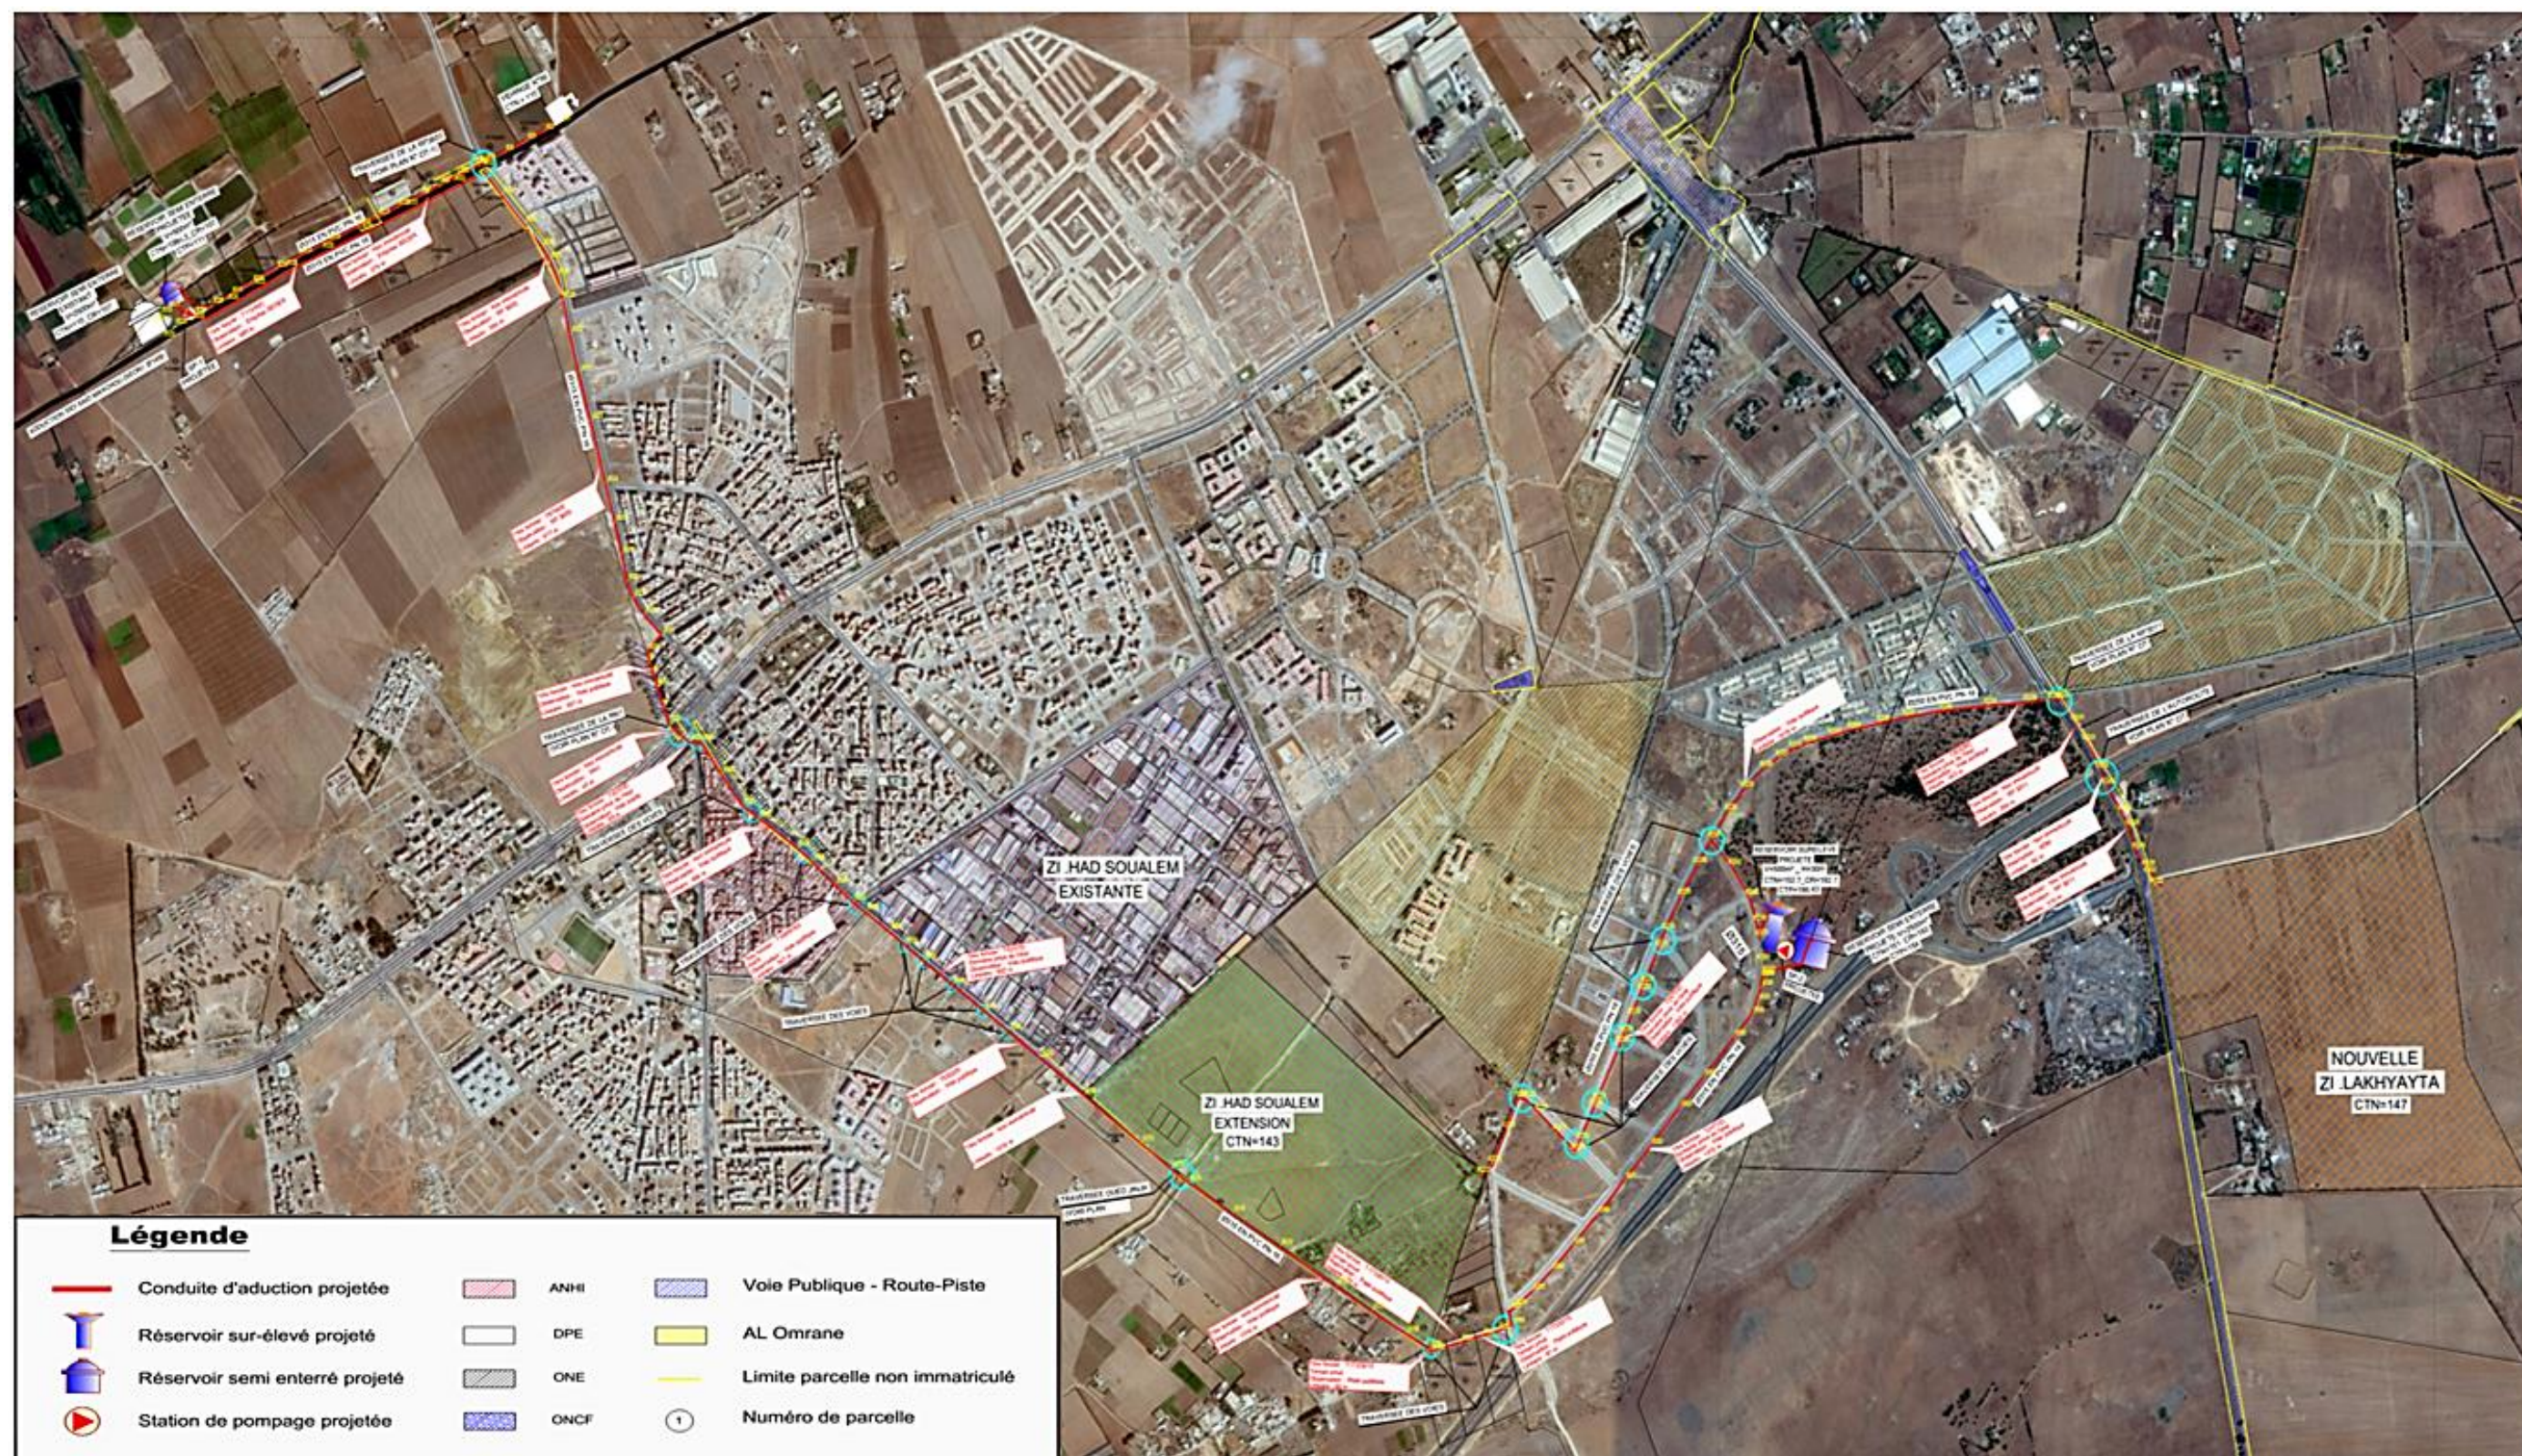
Vue en plan du réseau hors-site d'alimentation en eau potable de la zone du projet.
